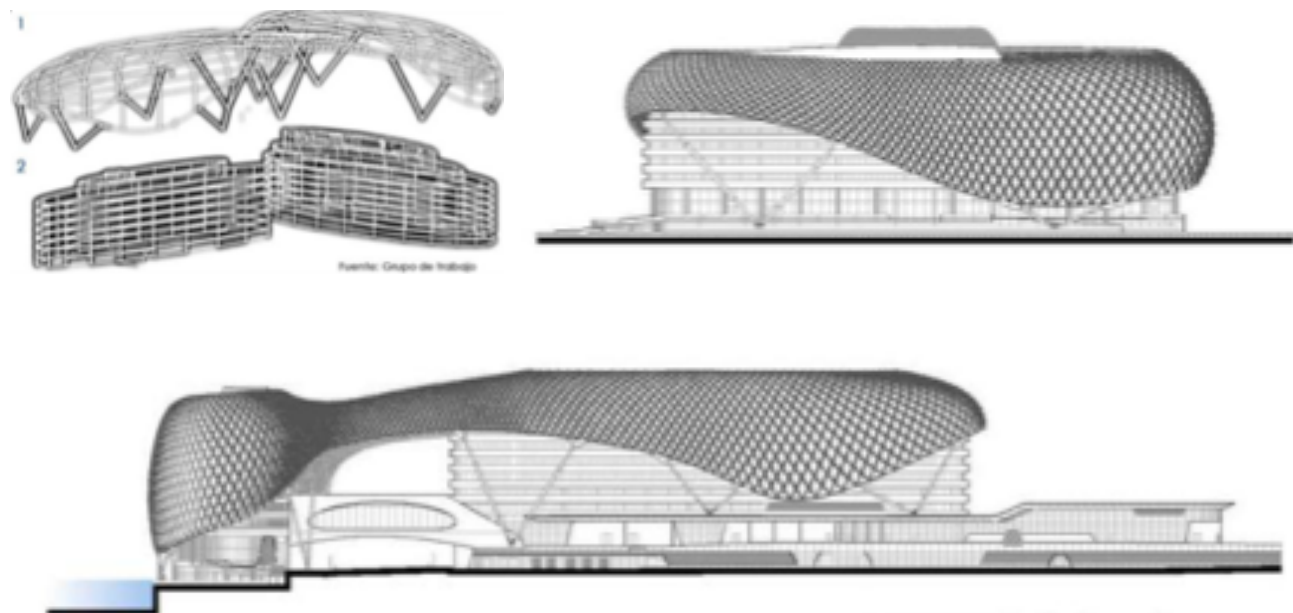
Detalles estructurales. Fuente: <http://www.asymptote.net>
